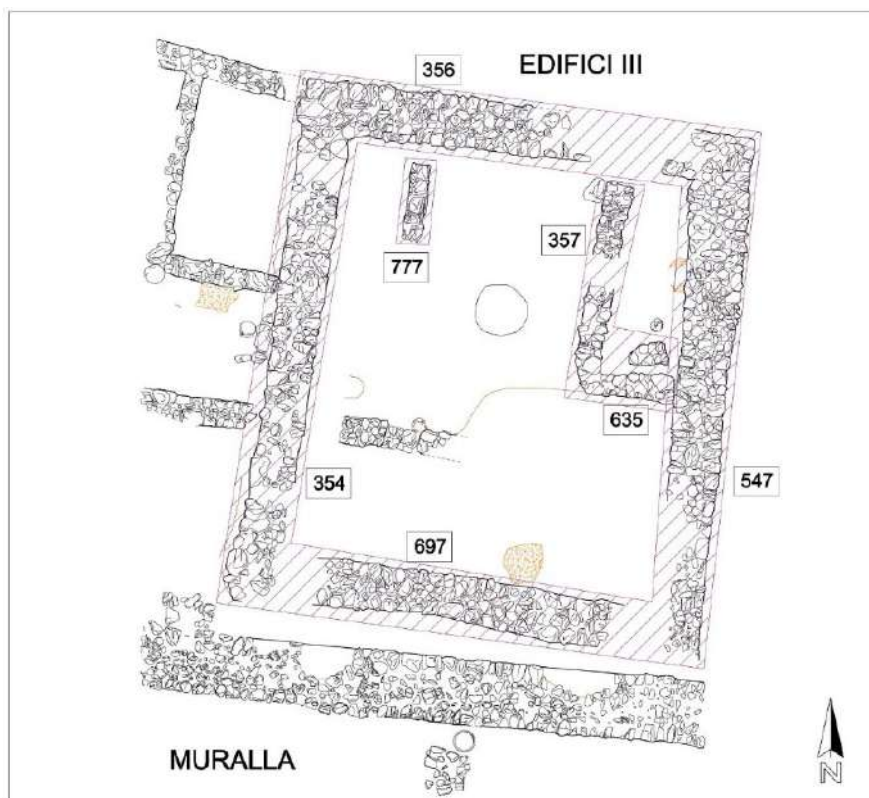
Planta de l'Edifici III amb les estructures a consolidar
